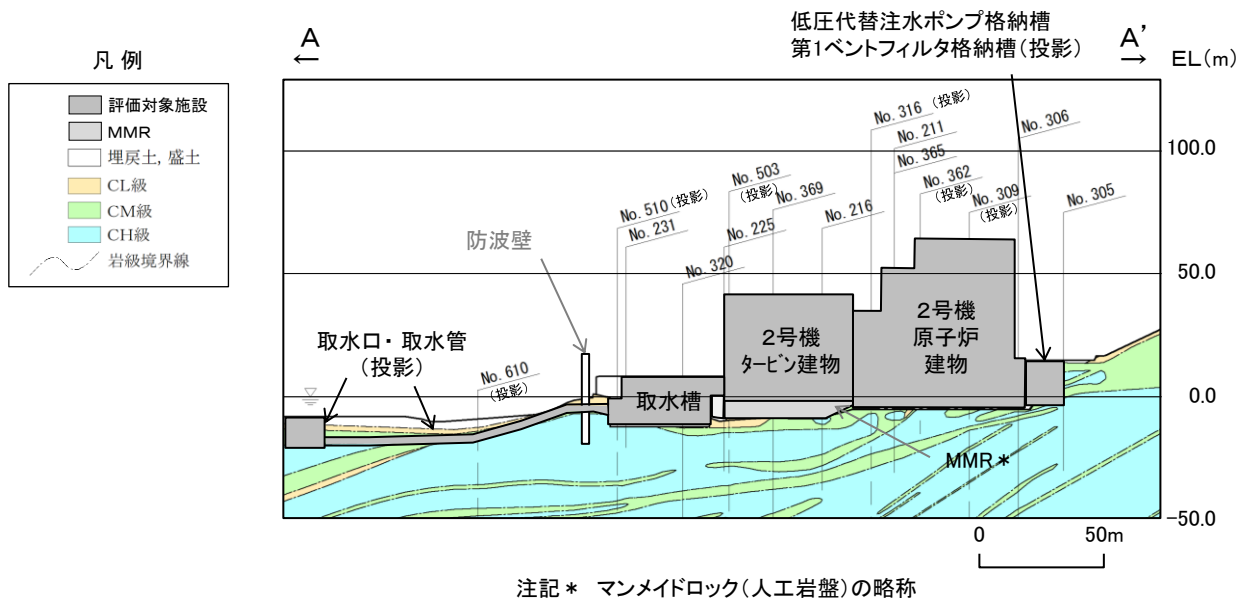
原子炉建物等の地質断面図 (A-A' 断面)
